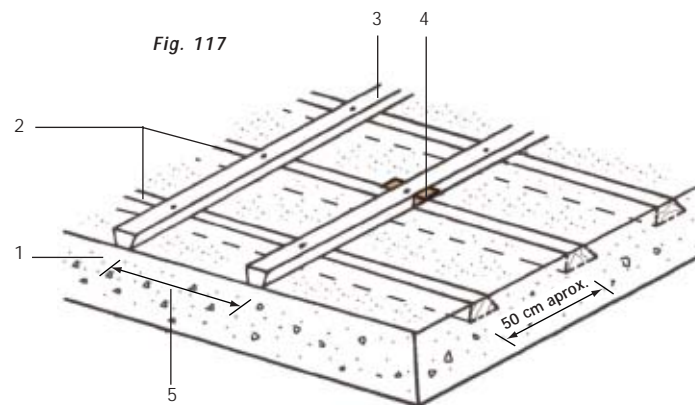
Detalhe do suporte base de concreto armado com caibros embutidos para receber as juntas elevadas com caibro.
